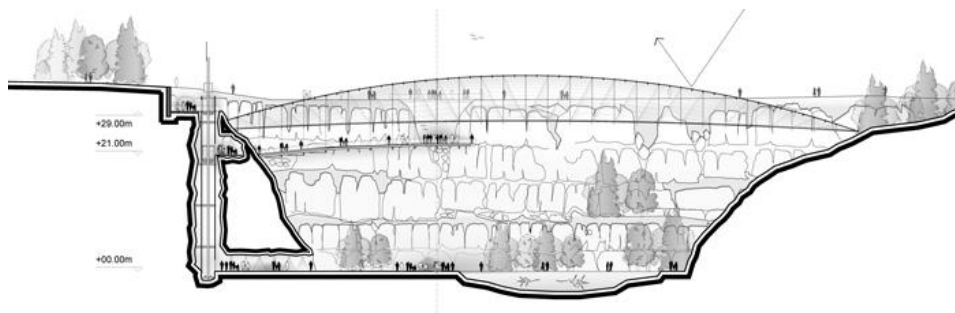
Проект будівлі музею у Портленді. Архітектурне бюро Renzo Piano Building Workshop
